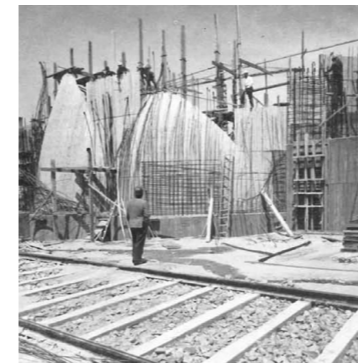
Imagen de la construcción, Parroquia Santa Ana
